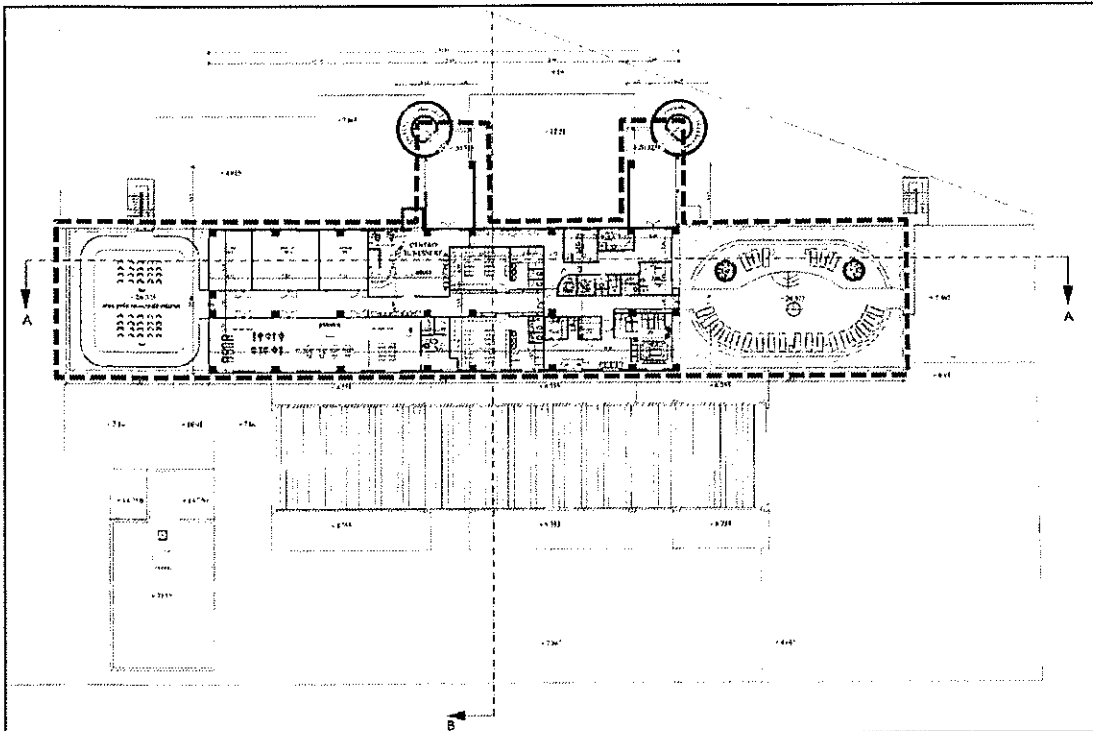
Progetto del piano sesto estratto dalla tavola allegata al PdC n. 59/2013.
